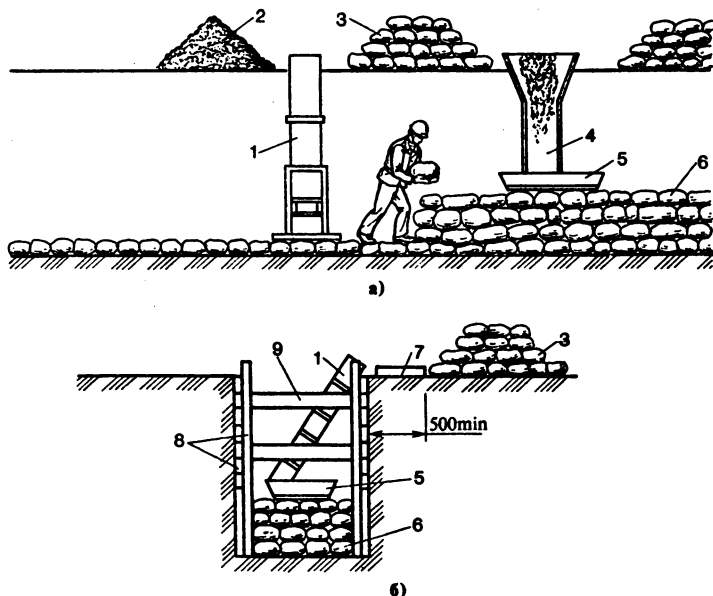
Организация рабочего места при бутовой кладке фундаментов в траншеях и котлованах глубиной более 1,25 м:
